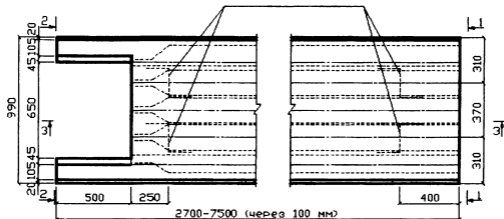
Устройство междуэтажных перекрытий с укладкой панелей в пробитые в стенах борозды
